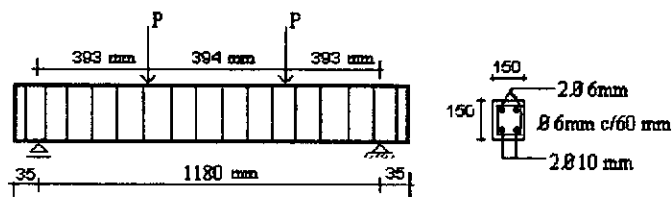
5 – Características das vigas ensaiadas por SHARIF et al.
